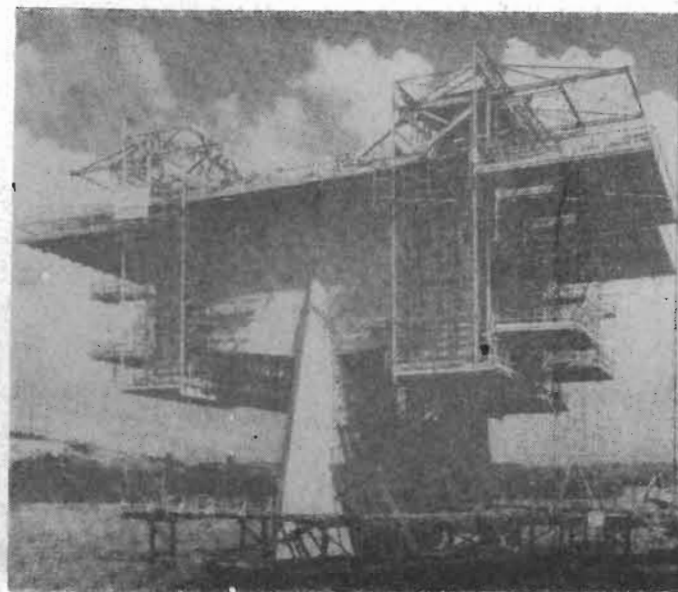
Armadura pretensada del voladizo principal de 104 metros de longitud del puente Bendorf sobre el Rin.
